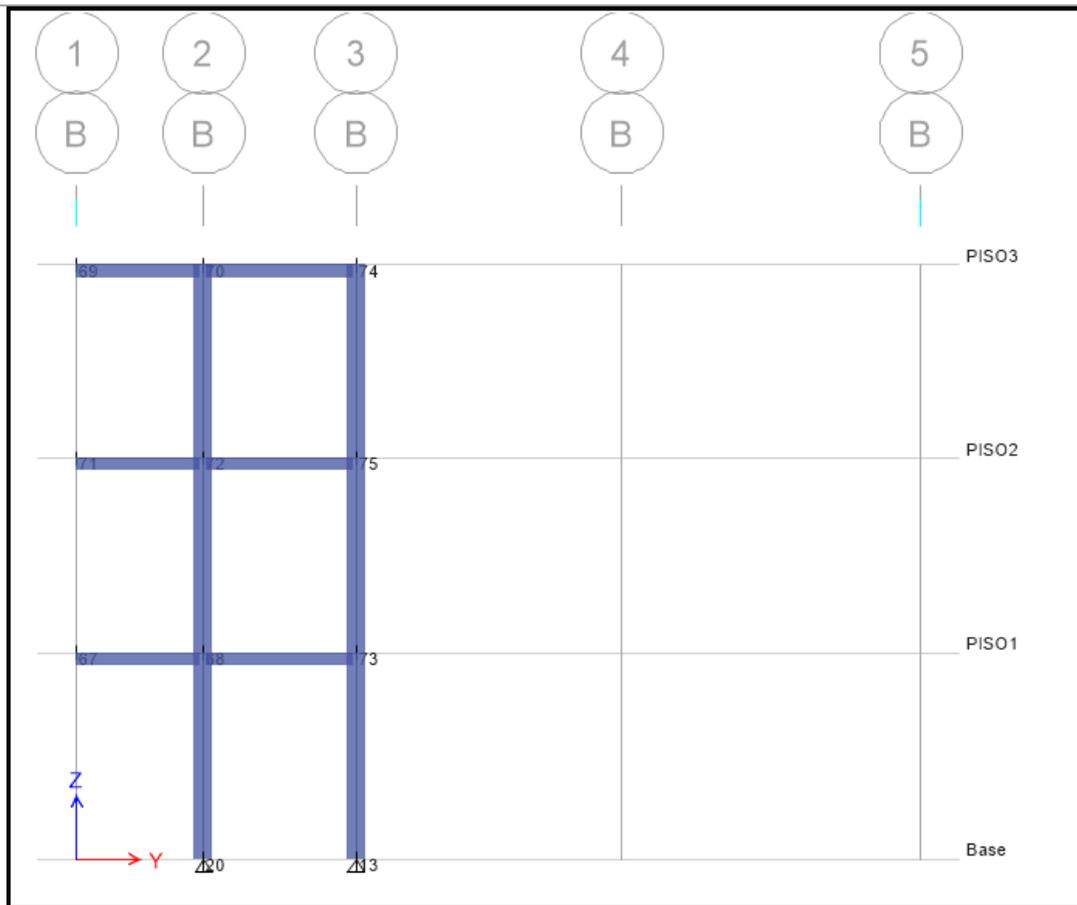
Eje B en el que se aprecian las vigas en el volado central.
